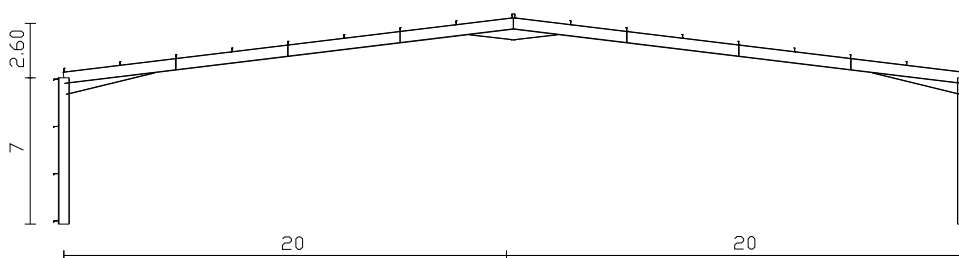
Pórtico rígido viga e pilar de alma cheia, vão de 40.00m com esquadros ligação pilar/viga, viga/viga
